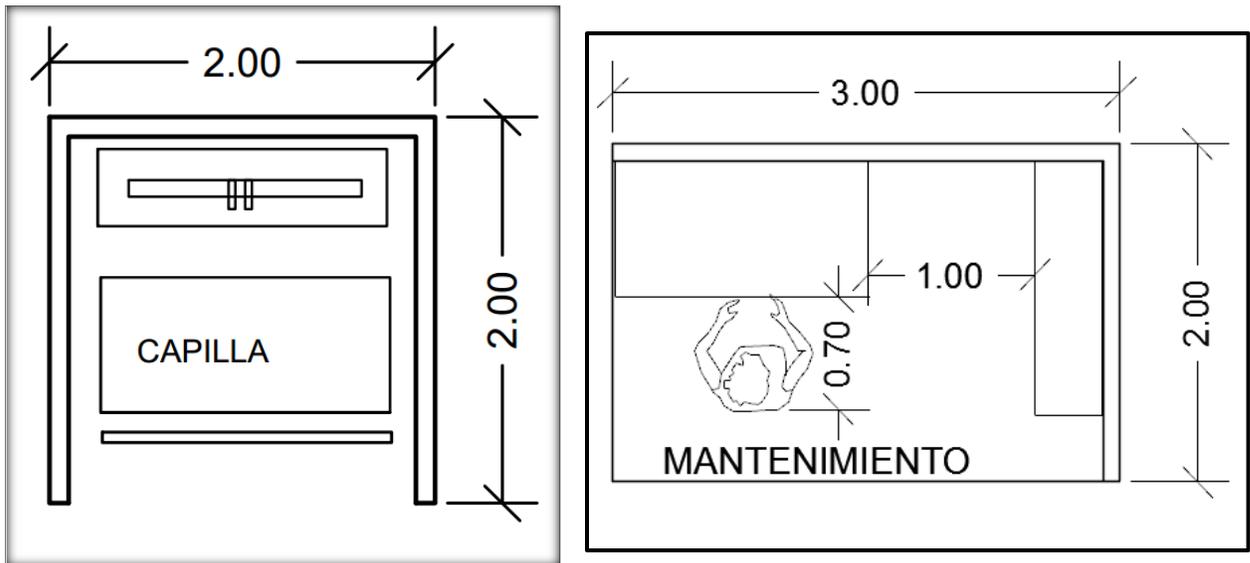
propuesta distribución en planta capilla y mantenimiento SIN ESCALA
